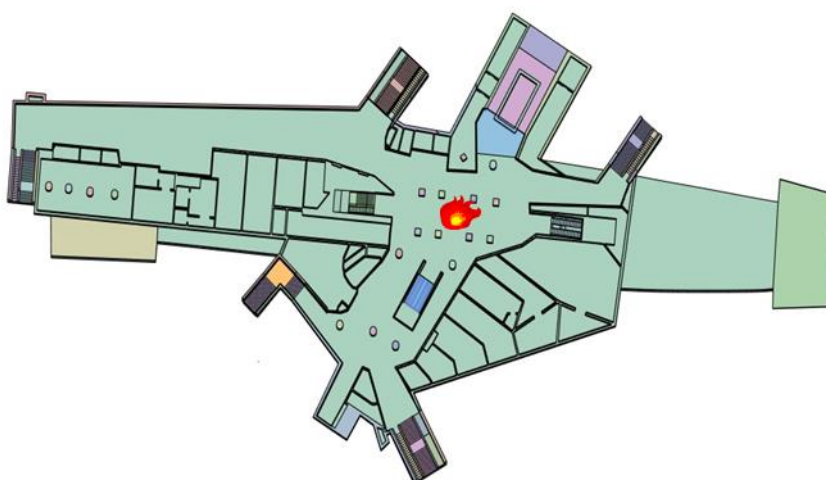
Position des Gepäckbrandes im Grundriss der Verteilerebene
